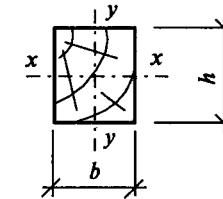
Сечение деревянной колонны — к примеру 5.4
